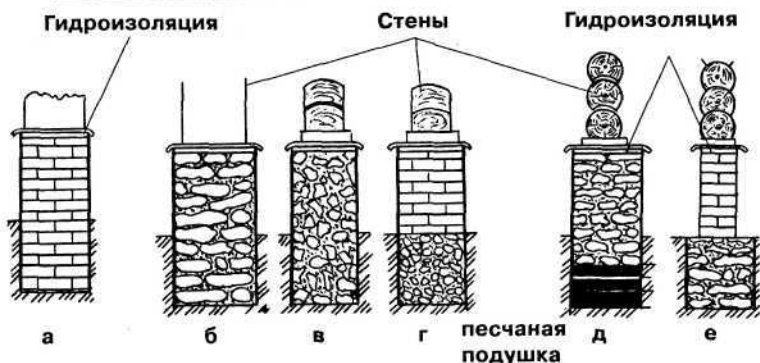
Устройство фундаментов из разных материалов: а — кирпичный; б — бутовый; в — бутобетонный; г — кирпичный по бетону; д — бутовый по песчаной подушке; е — кирпичный по буту
